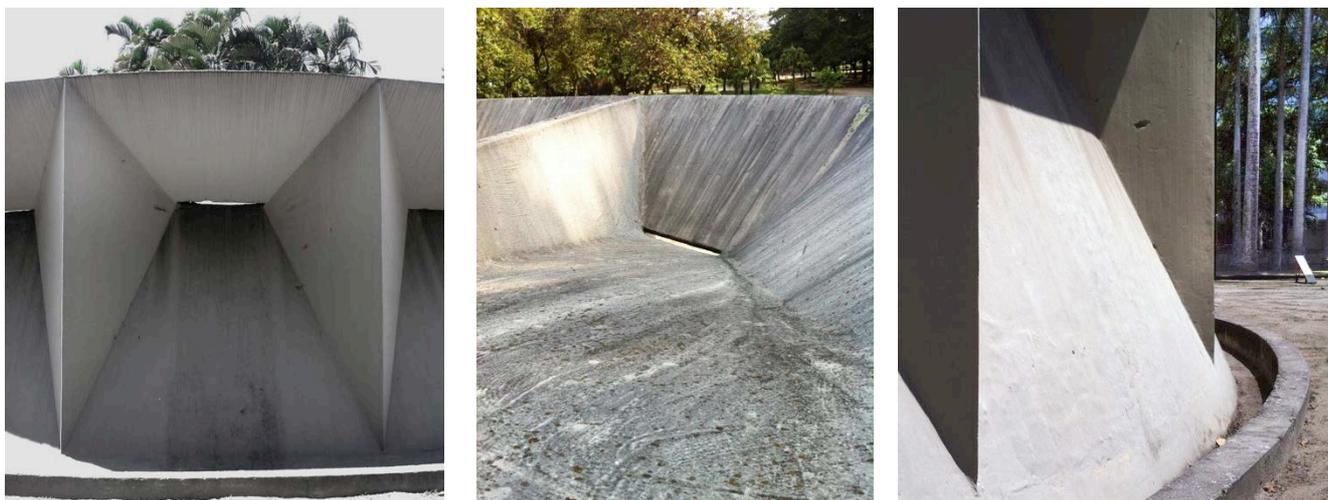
, 78, 79 e 80. Vistas do módulo de fachada, cobertura e apoio do edifício; Fachada principal e cortes do pavilhão do Morro da Viúva.
